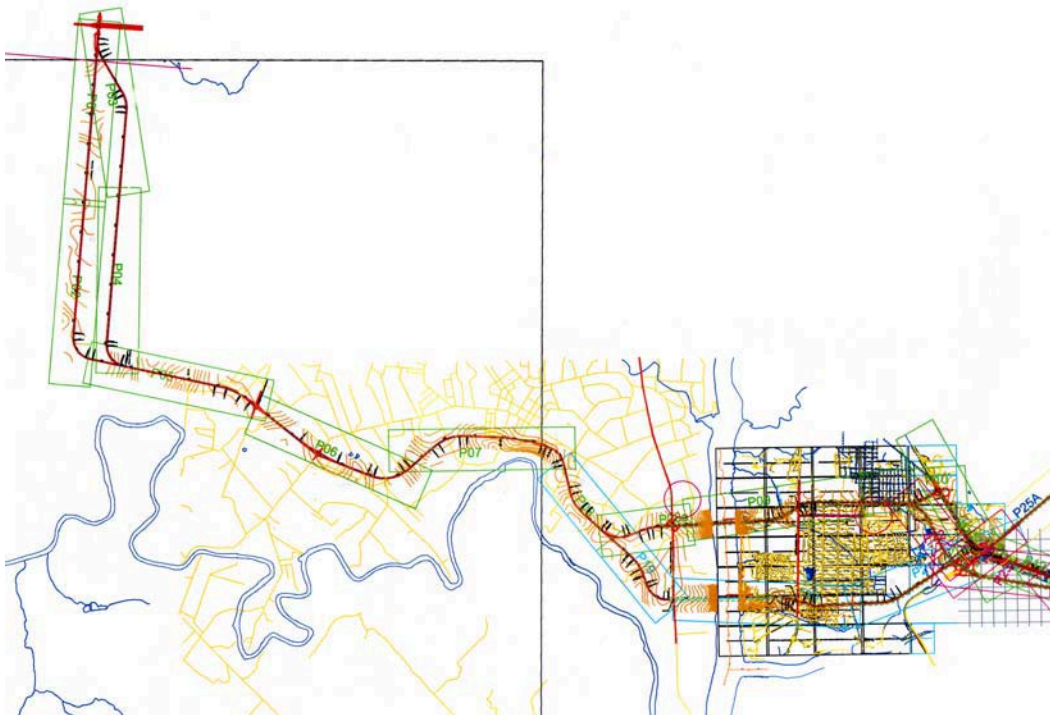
Proyecto de Construcción del Segundo con el Brasil
